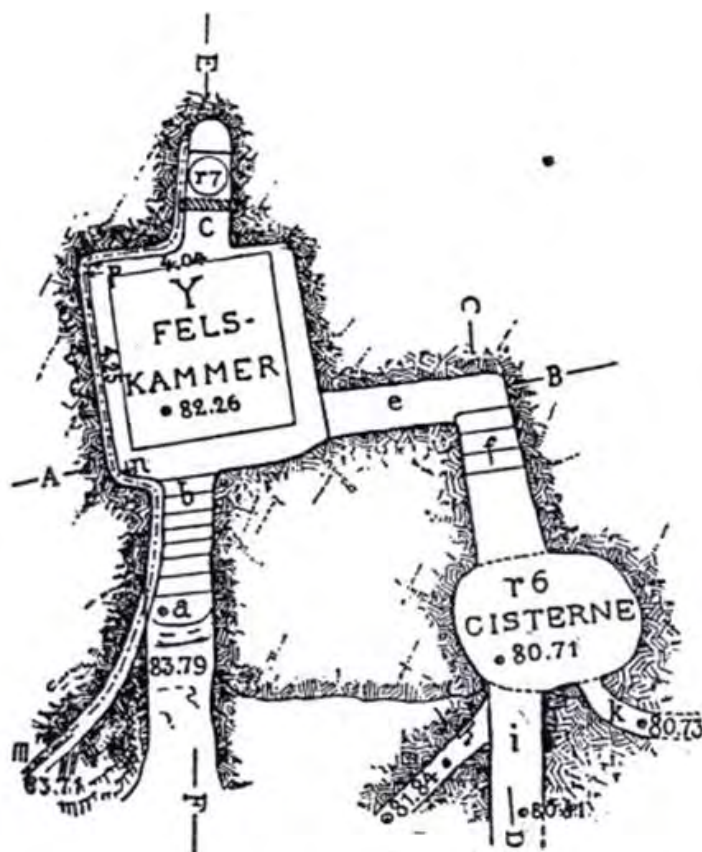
Grundriss der älteren Wasseranlage.
